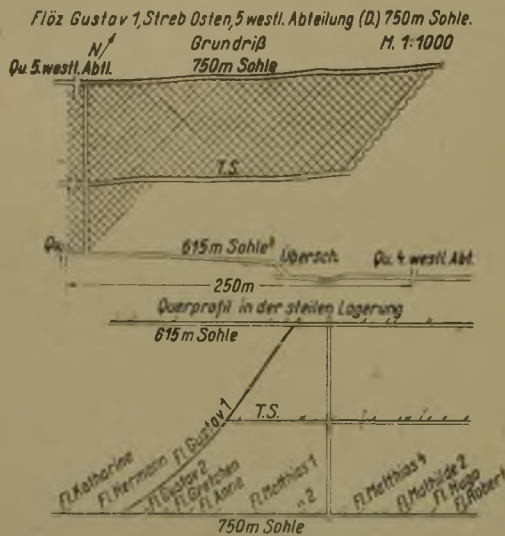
Ausrichtung in steiler Lagerung für Abbauführung mit Schrägbau.
